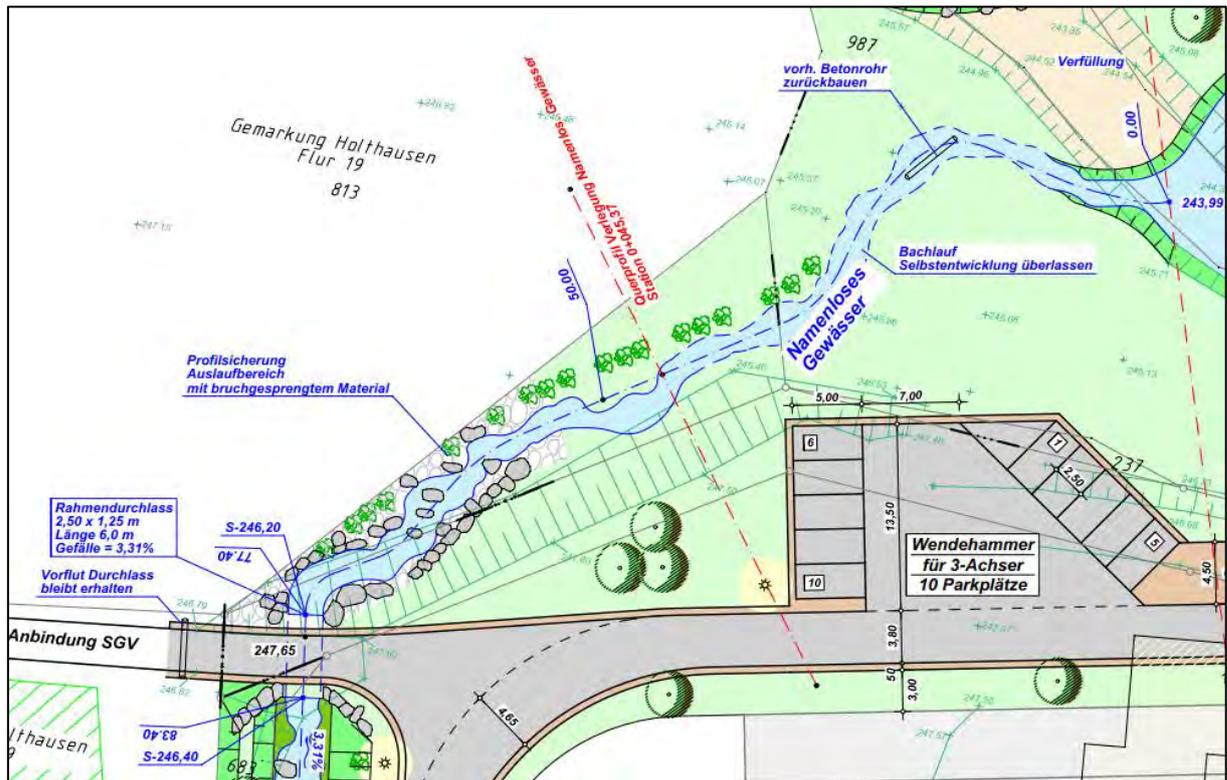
Planung Abschnitt Elseaue (Ausschnitt Lageplan)
